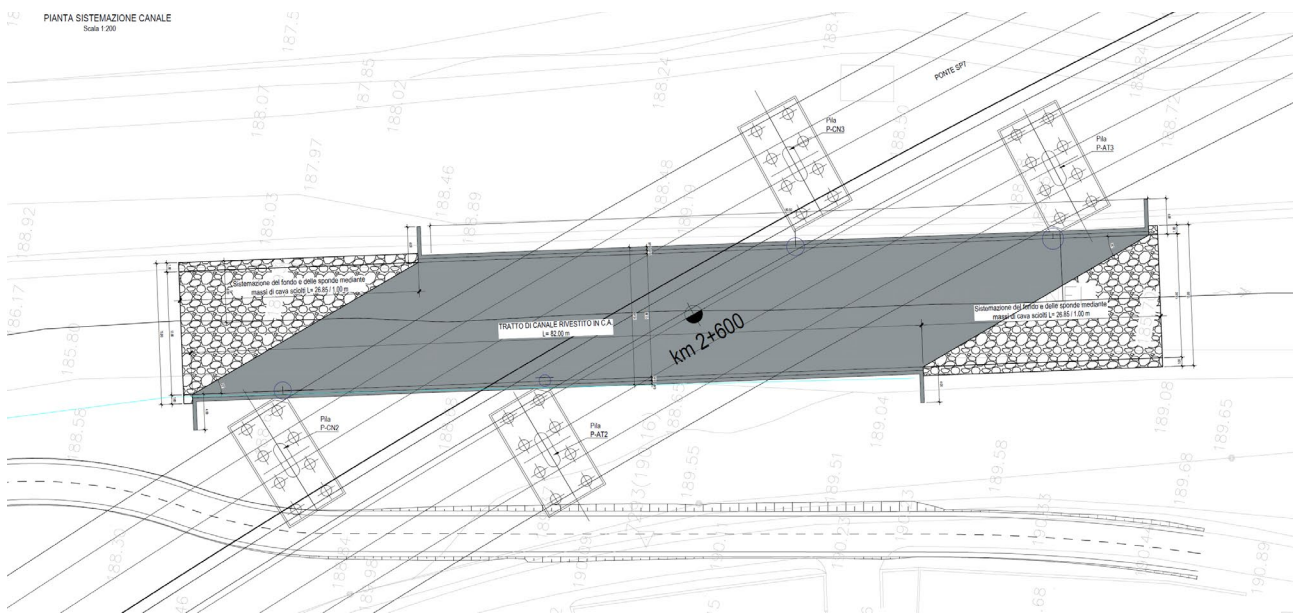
Planimetria sistemazione canale Verduno sotto viadotto SP7
